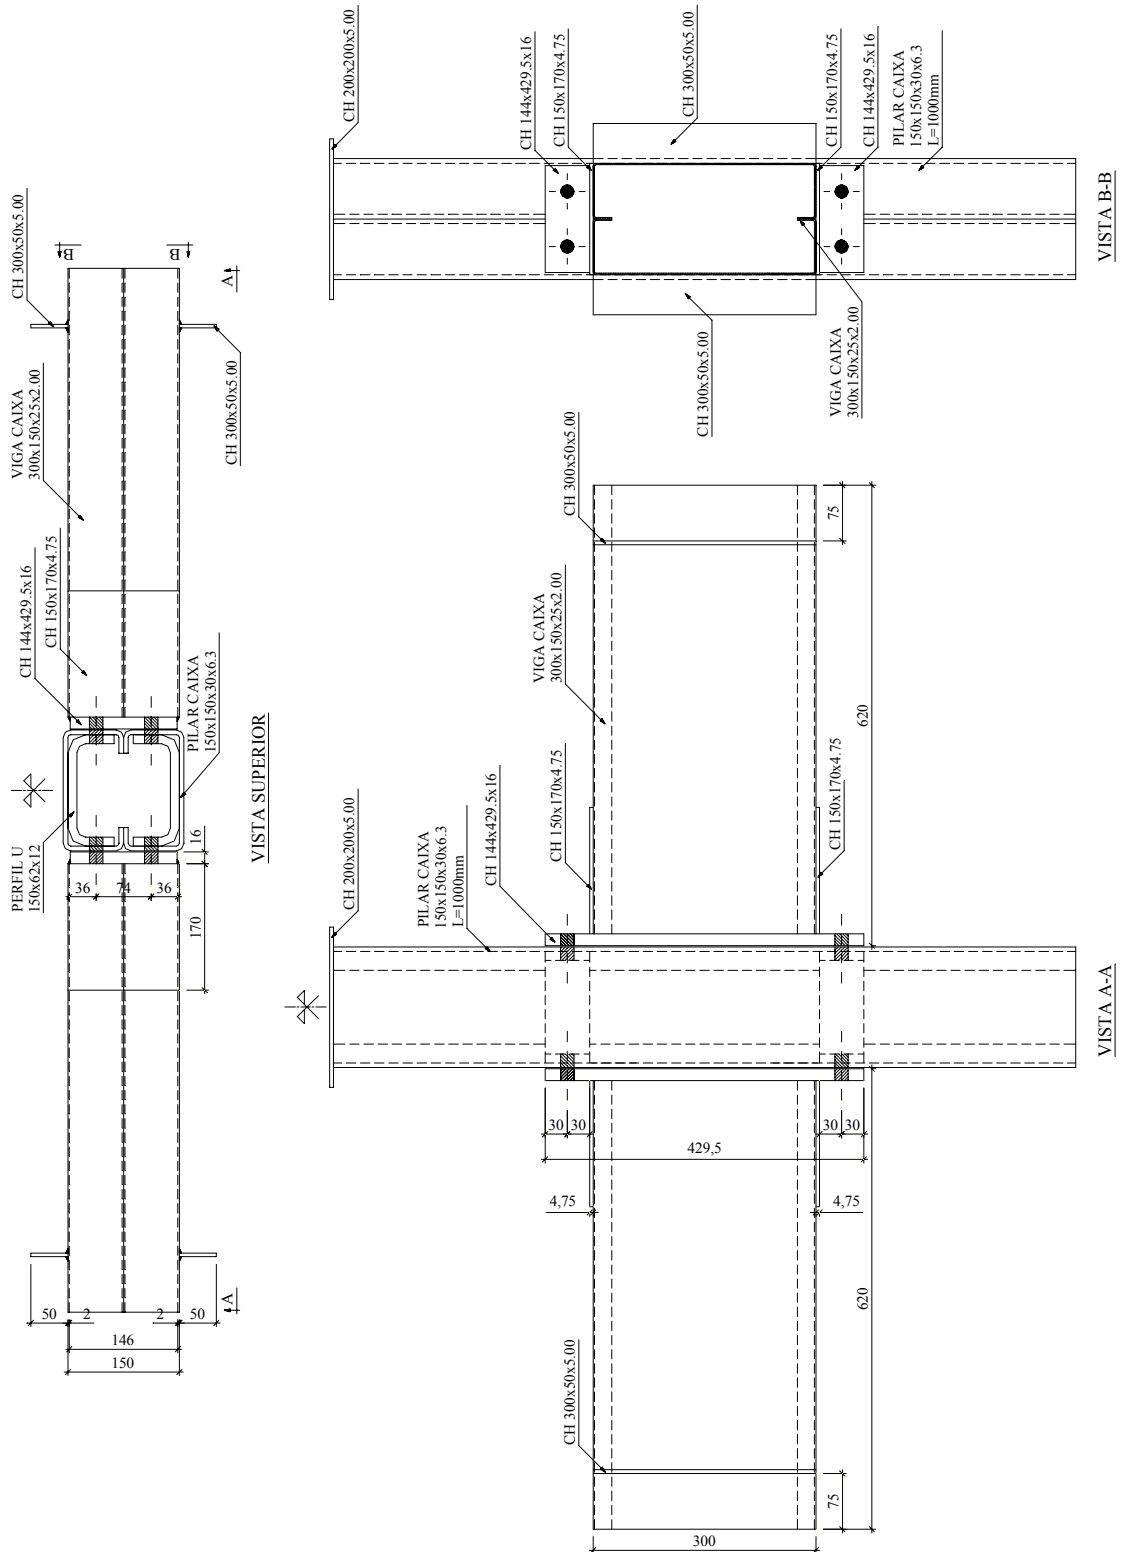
Ligação 04BR: rígida na maior inércia do pilar.
